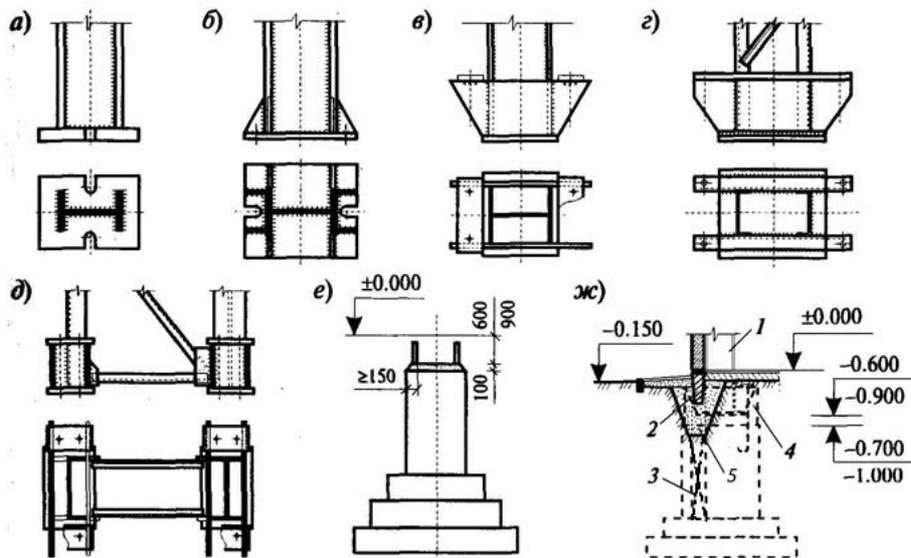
База стальных колонн и способы опирания их на фундаменты:
